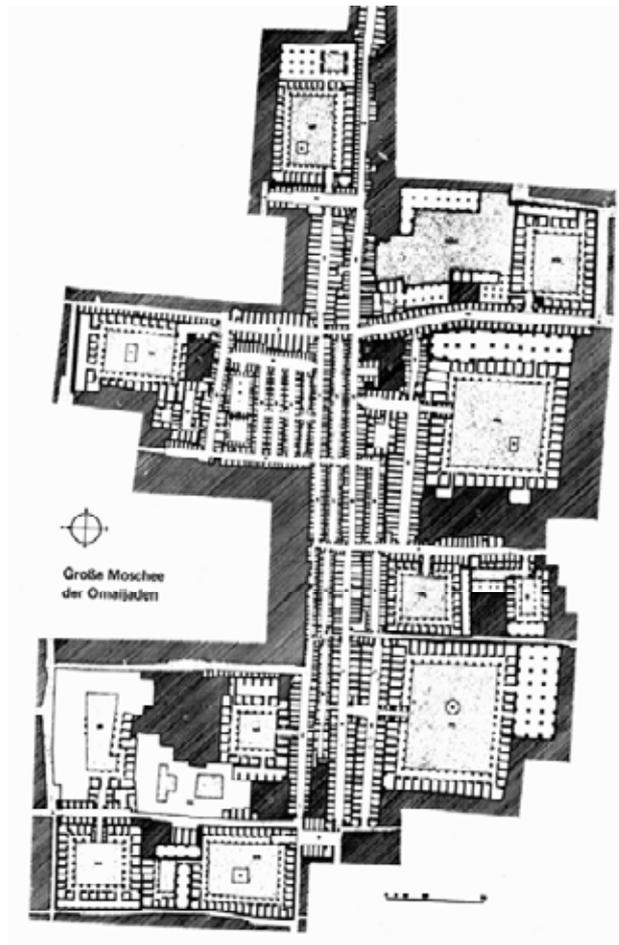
Grundriss des Bazars von Aleppo.
